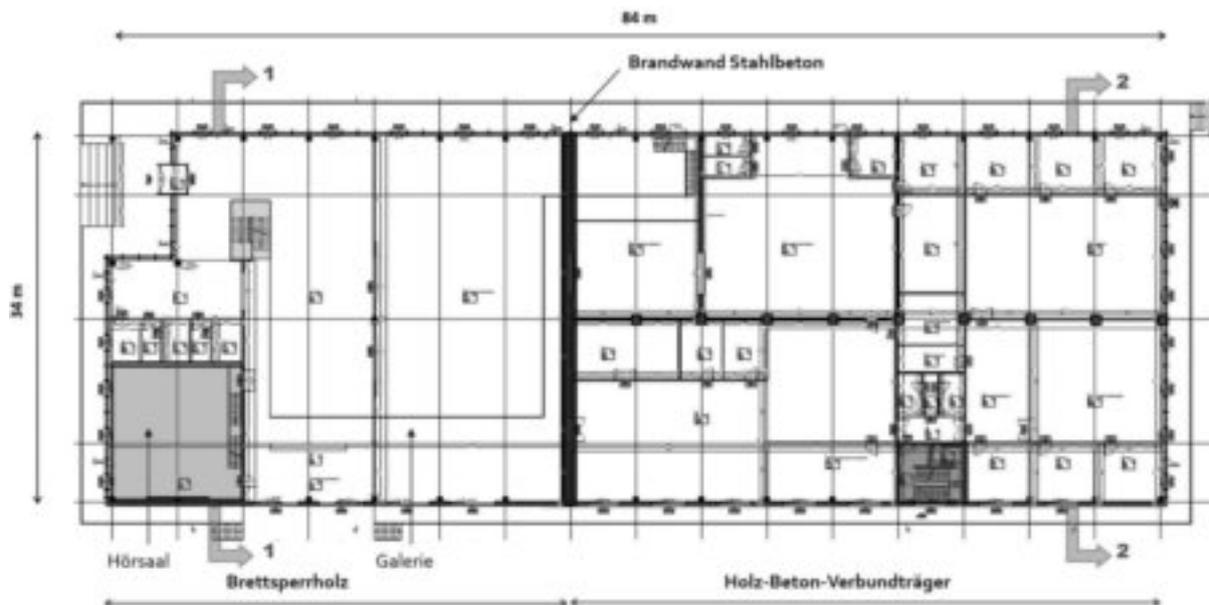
Grundriss Jowat [IfuH Architekten]
